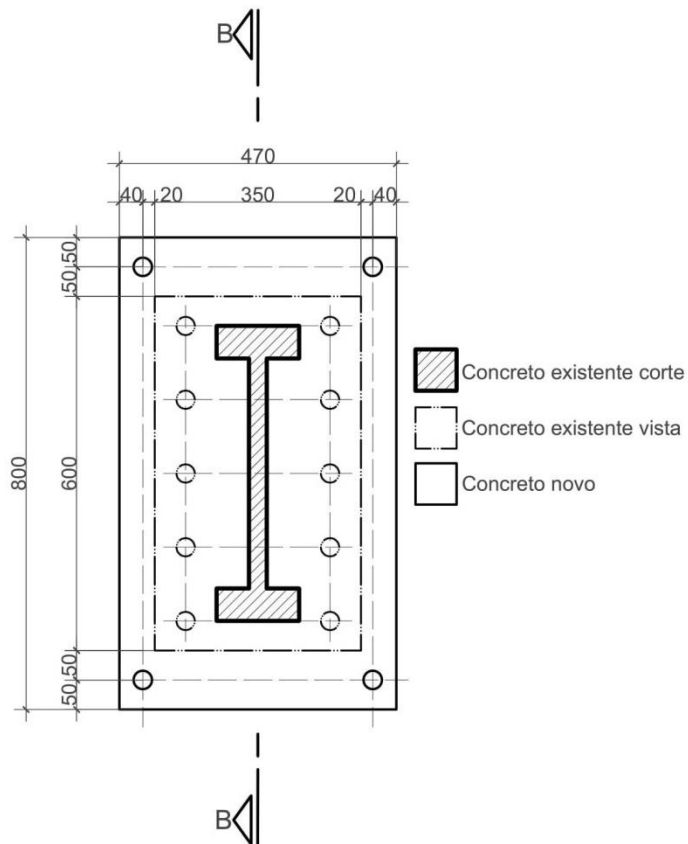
Forma dos blocos de fundação reforçados - Planta
